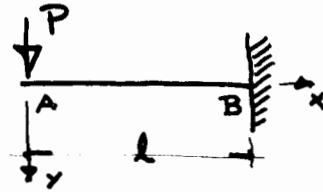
Vigas conjugadas correspondientes a diversas vigas reales
